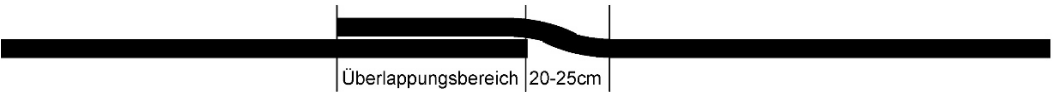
Stark gekröpfte Längsstäbe ($d_s \geq 25$ mm) im Unterzug in der Seitenansicht beim Überlappen (Stoßen)
